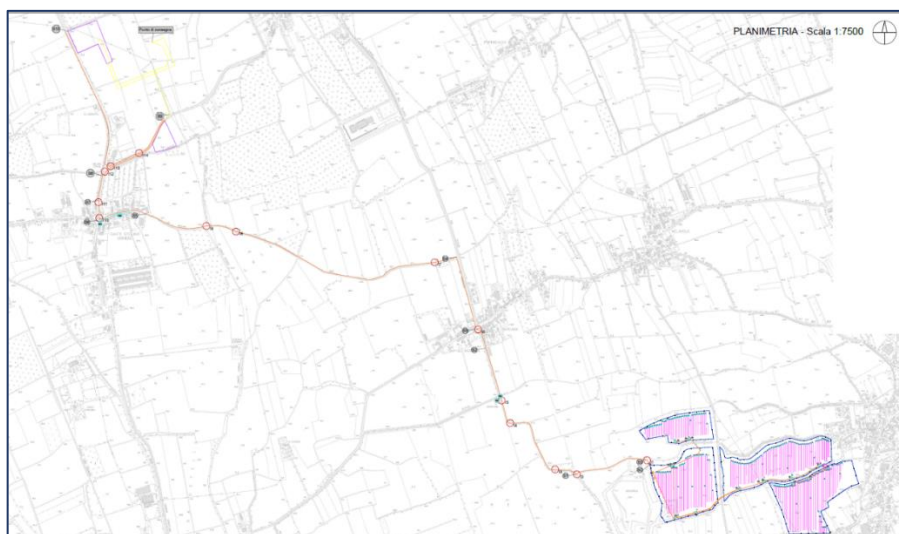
Planimetria generale linea di collegamento cavidotto con interferenze – Trivignano Nord – ST
